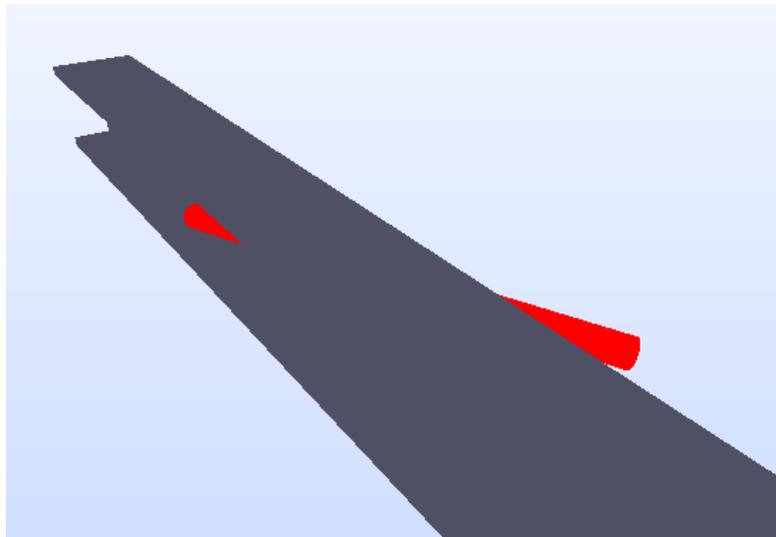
Conflicto de tubería que corta una viga. Fuente Propia
